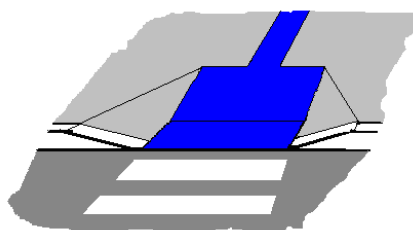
Pavimento tátil de alerta no acesso principal e na faixa de presença
